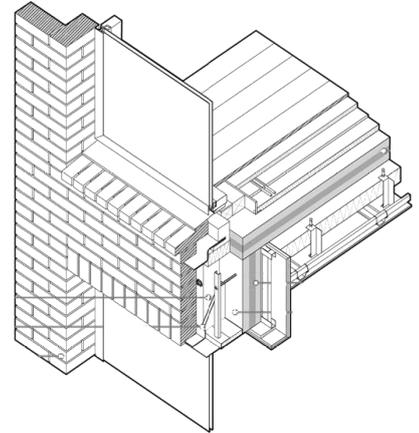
detalle fachada Dalston Works, Waugh Thistleton Architects
